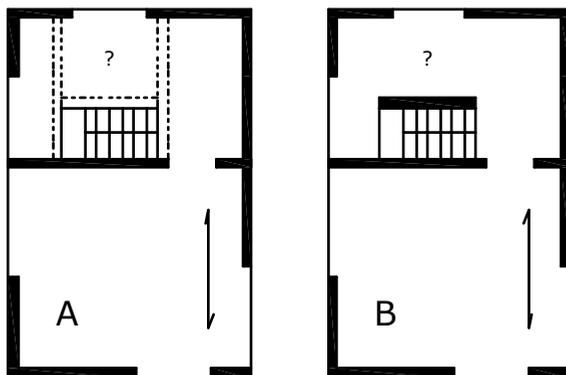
Disposizione in pianta dei solai. L'apertura del vano scale deve essere rinforzata con travi (tratteggiate) come in A, oppure deve essere presente un muro per appoggiare il solaio come in B.
